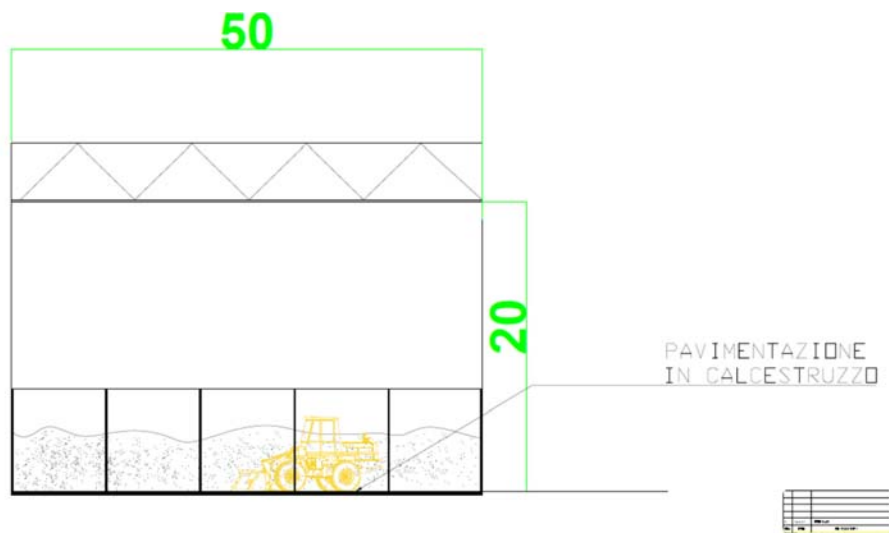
Vista laterale dell'area A dell'edificio "Temporary Storage Area".
